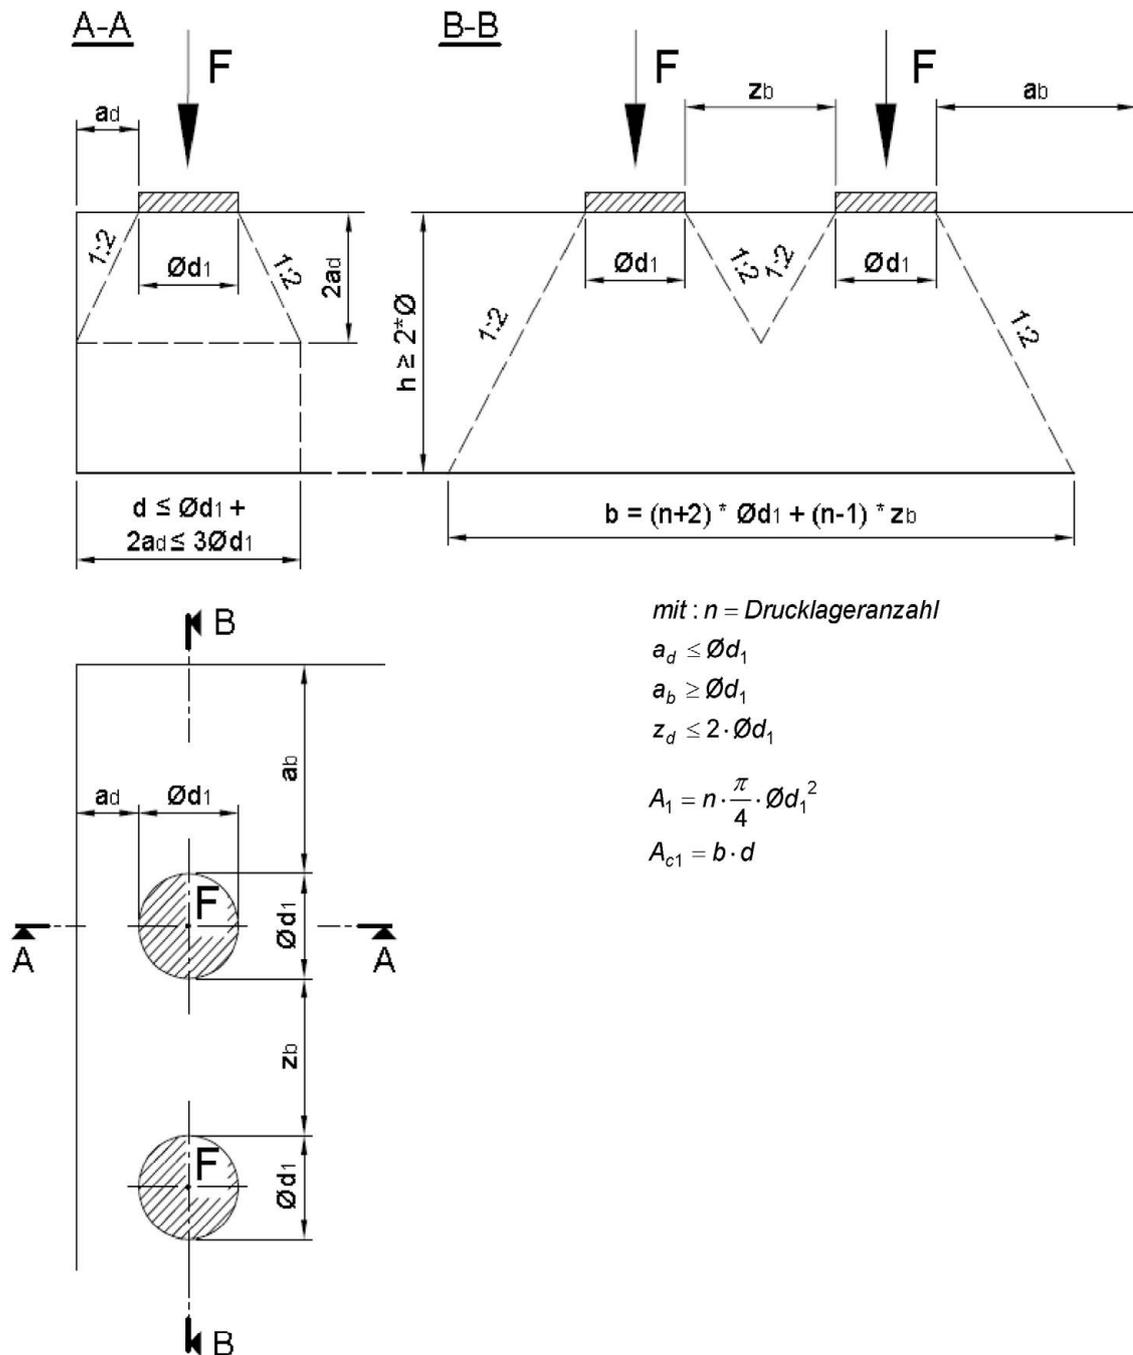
Bestimmung der rechnerischen Verteilerfläche  $A_{c1}$  nach Leonhardt (Vorlesung über Massivbau – Teil 2: Sonderfälle der Bemessung im Stahlbetonbau)
